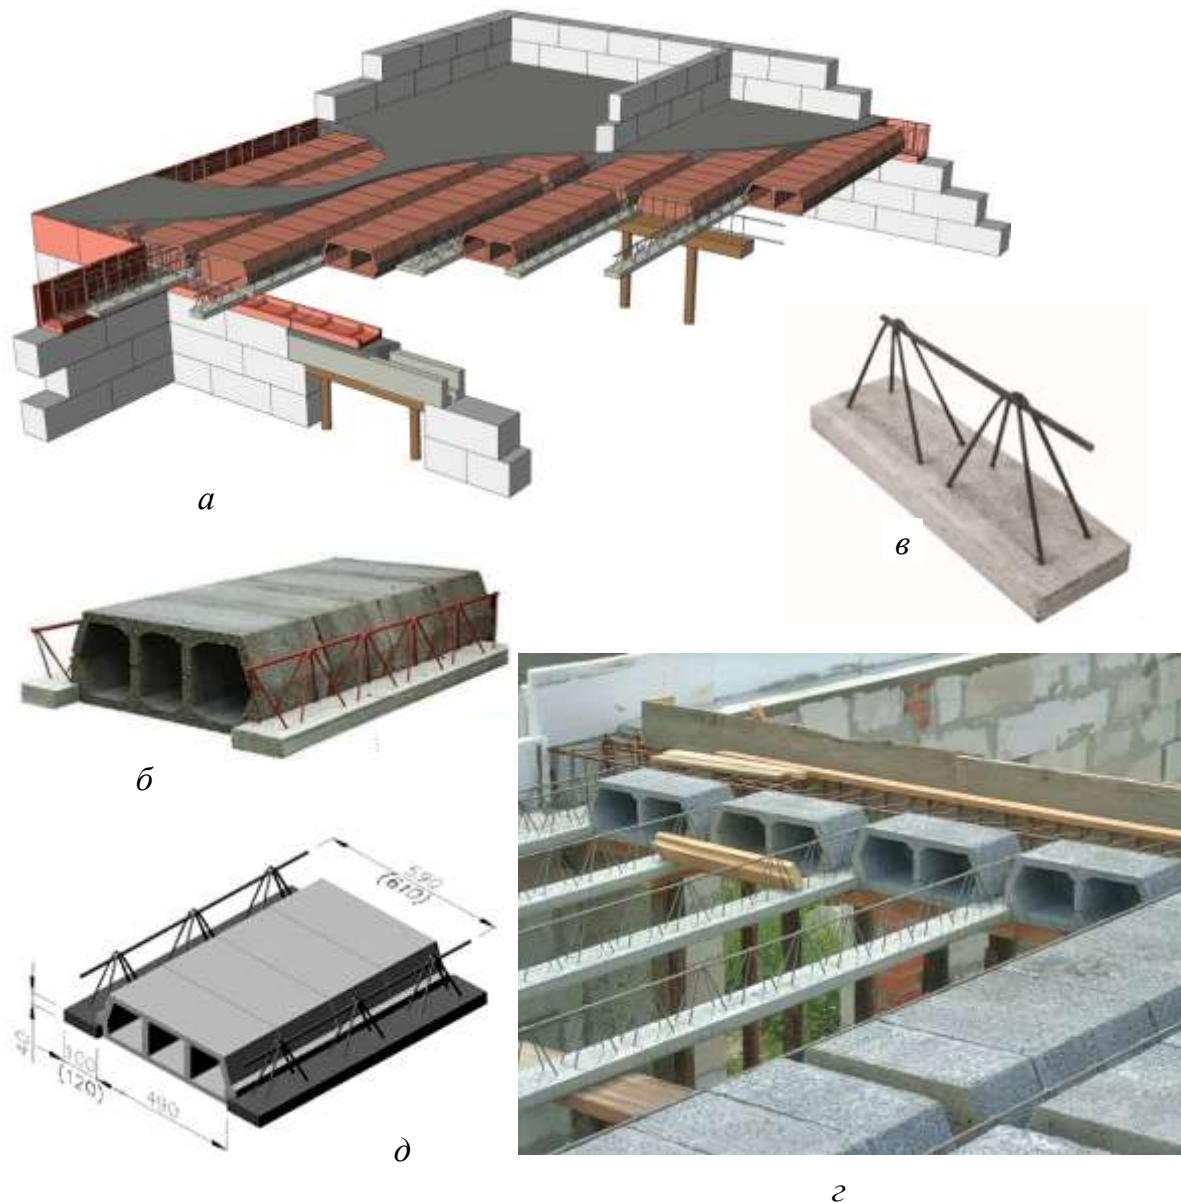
Збірно-монолітні перекриття по залізобетонних балках:
